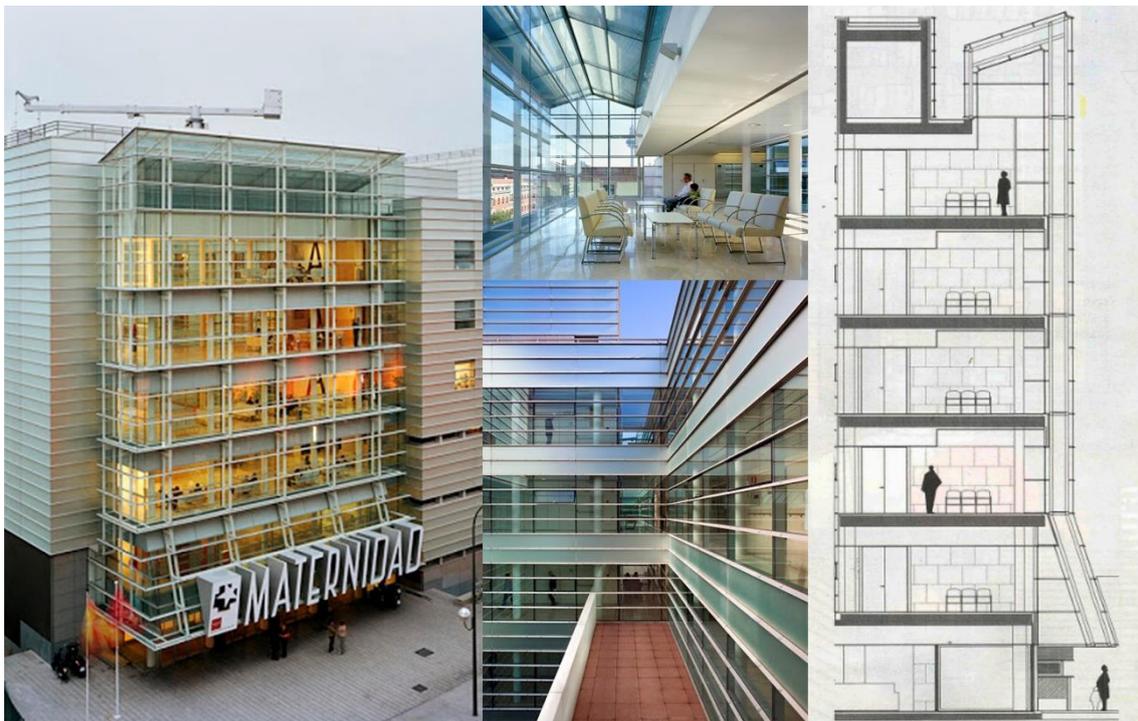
Fachada exterior, fachada interior, sala de espera y detalle muro cortina fachada.
